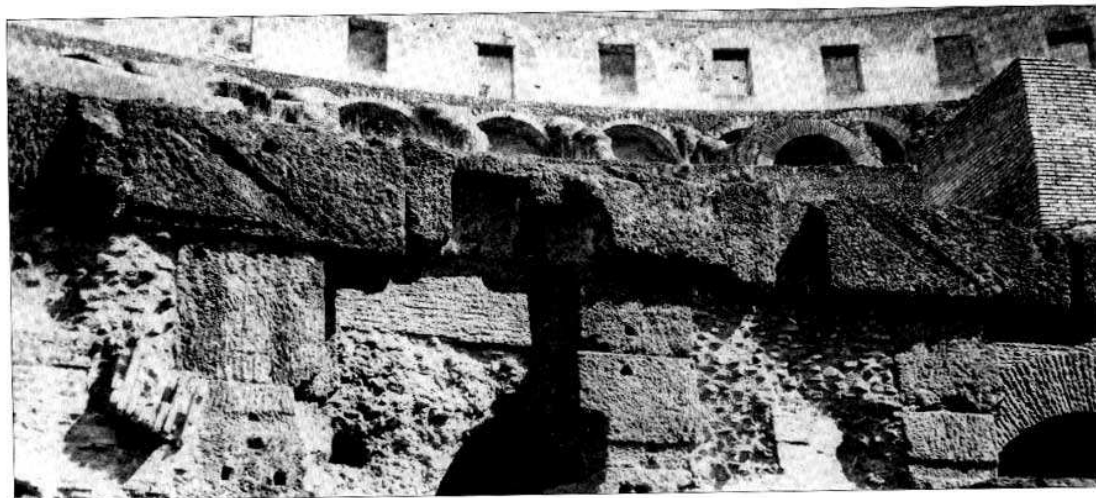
Due architravi del muro 1 che non appoggiano al centro dei pilastri
